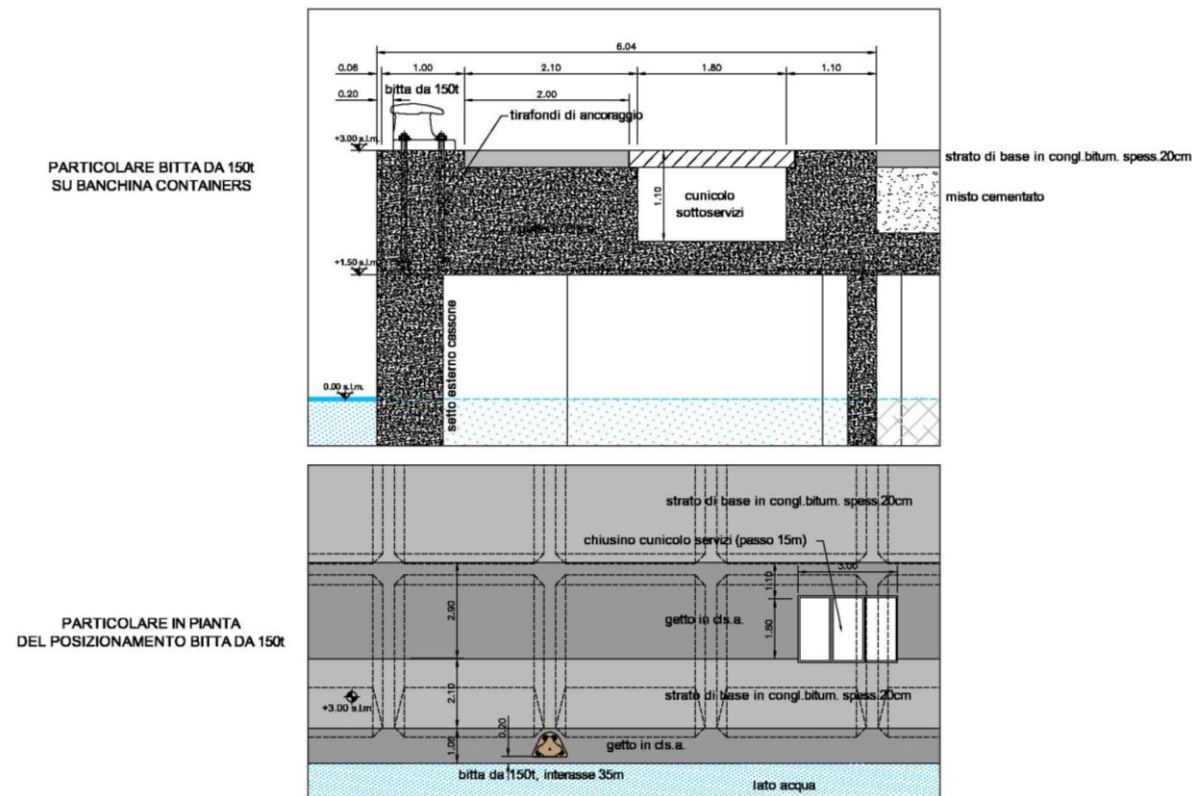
Banchina containers – particolare della bitta di ormeggio da 150t
